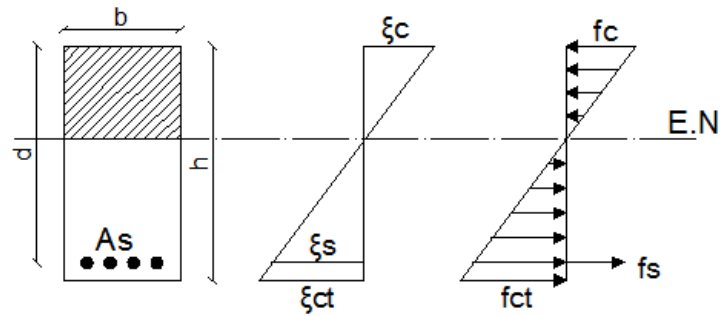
2 Esfuerzos y deformaciones que se producen en una viga no fisurada.
